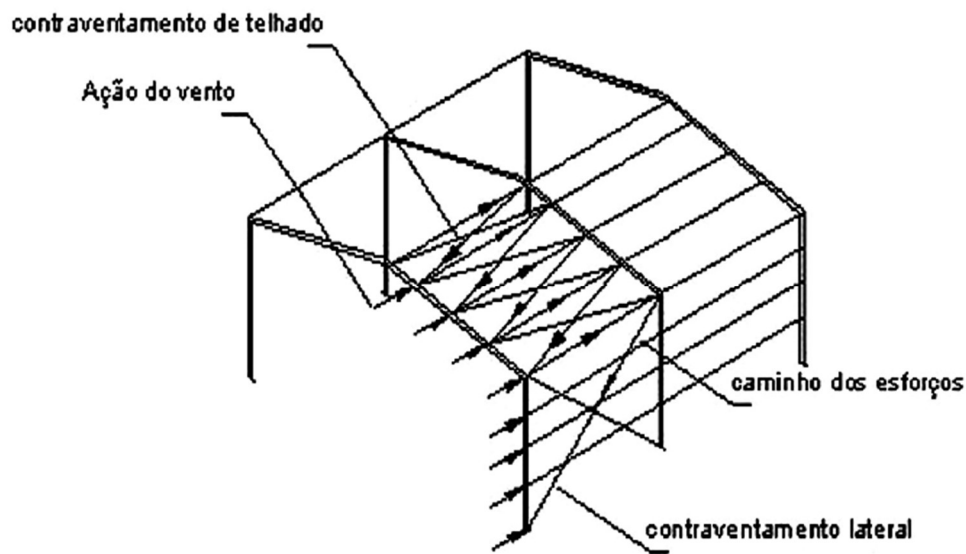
Sistema de contraventamentos de um pavilhão [8]
